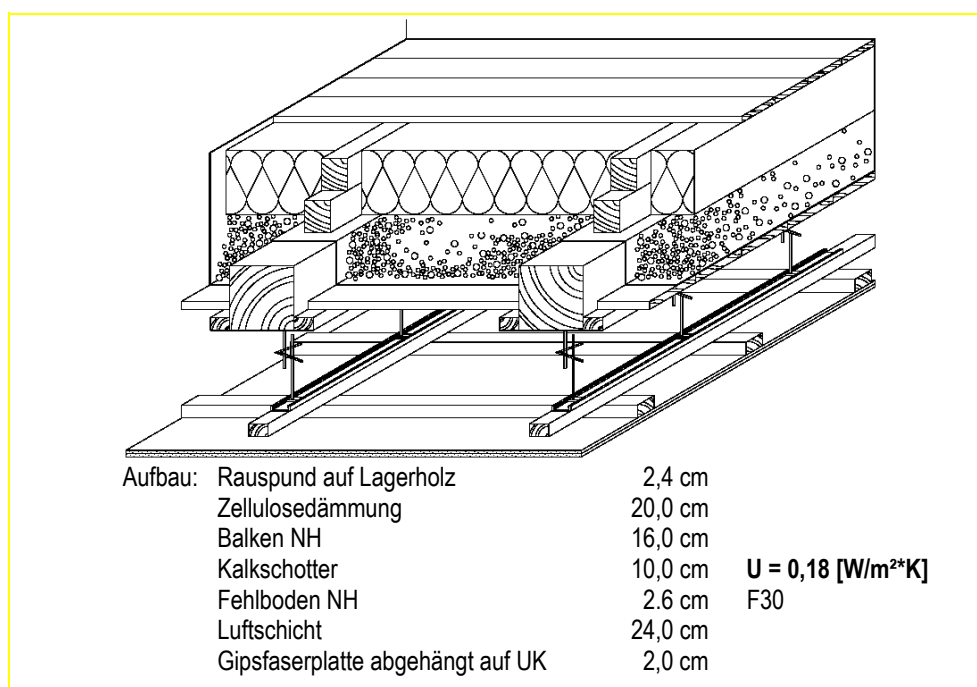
Komplettaufbau gedämmte Decke zum Dach, unbelüftet, Unterdecke, Brandschutz F30 (SIR 2002, Element-Nr. 135049425)
